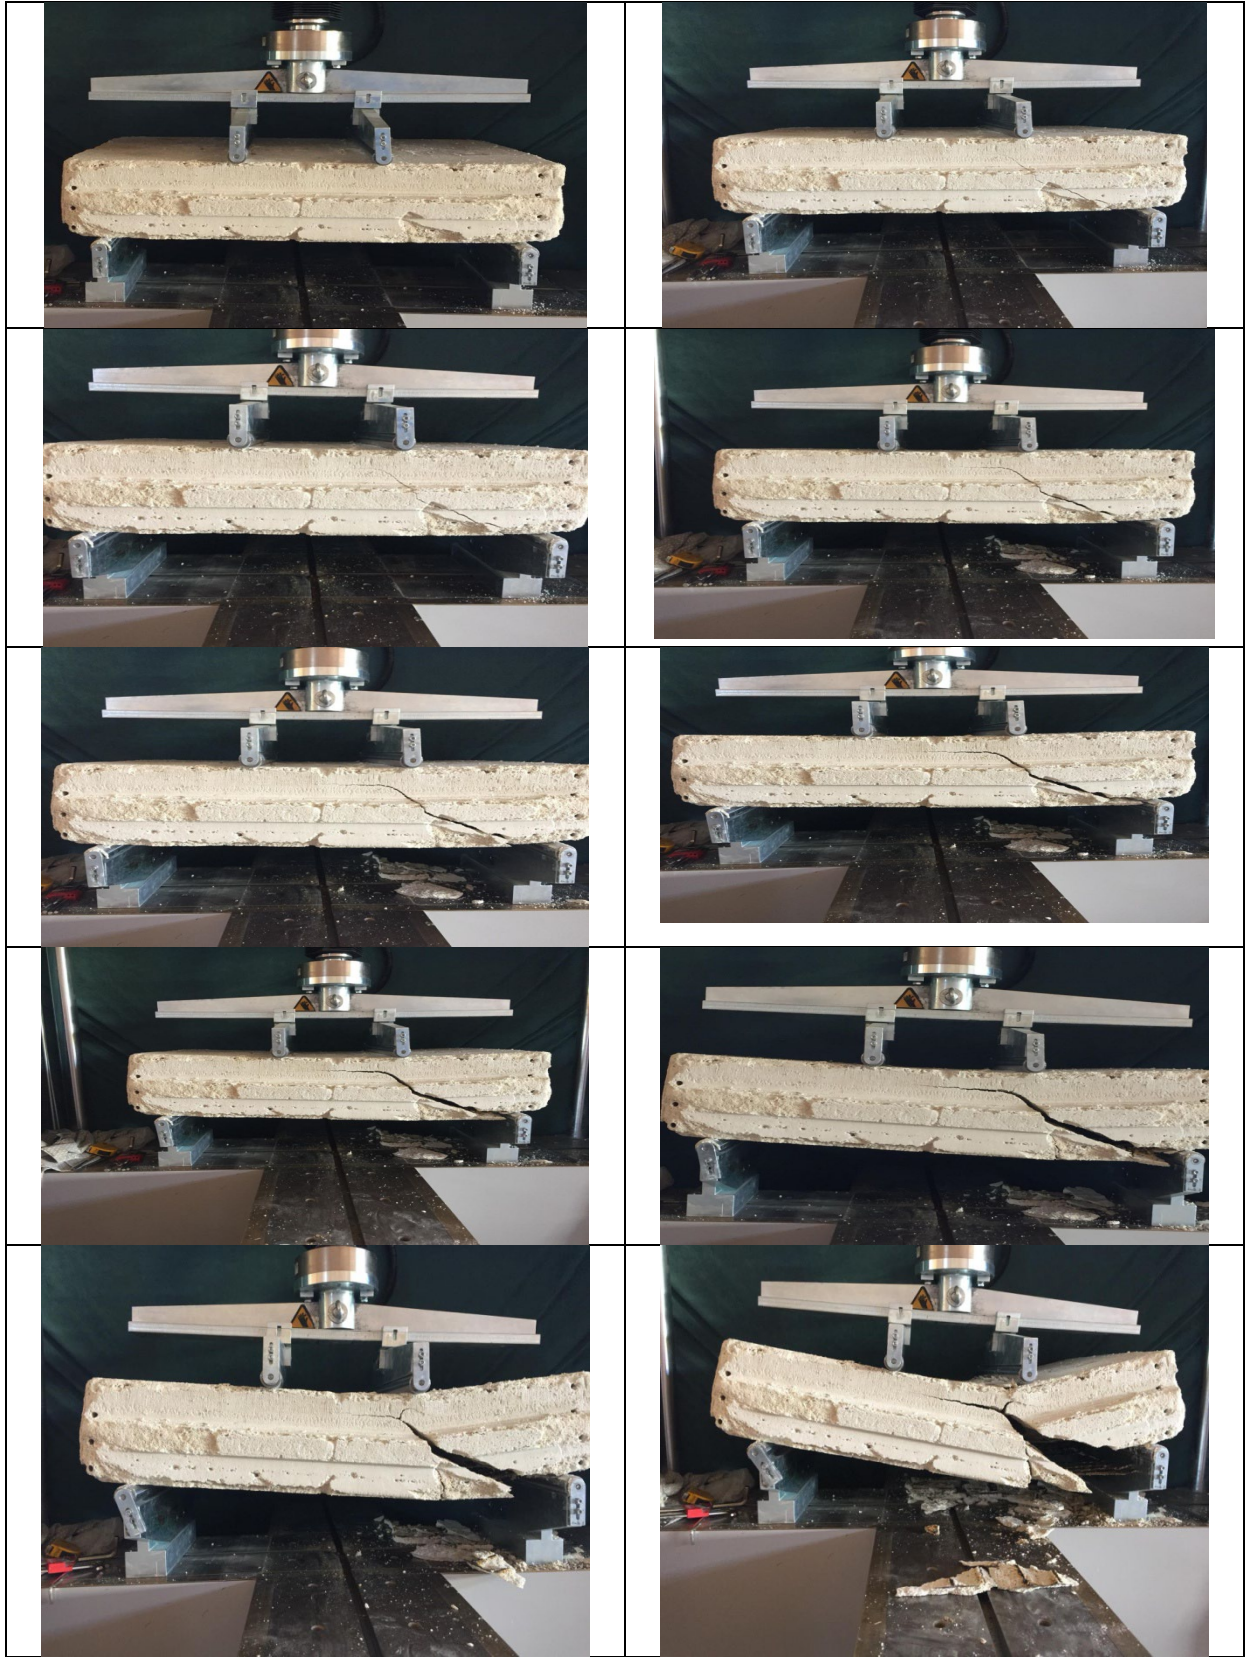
180 gün sülfat ortamında bekletilen donatılı gazbeton panelin görünümü.
